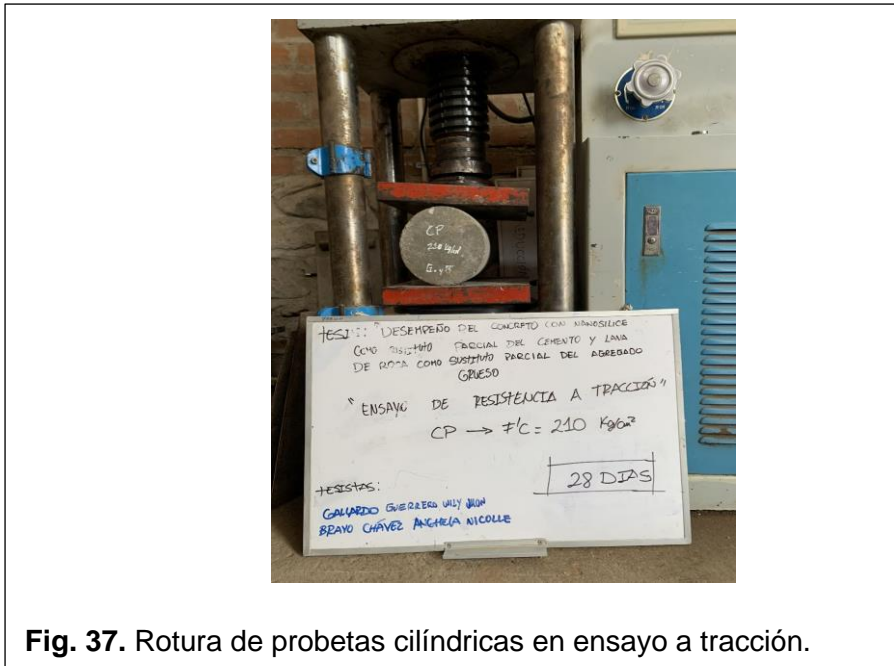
Rotura de probetas cilíndricas en ensayo a tracción.
